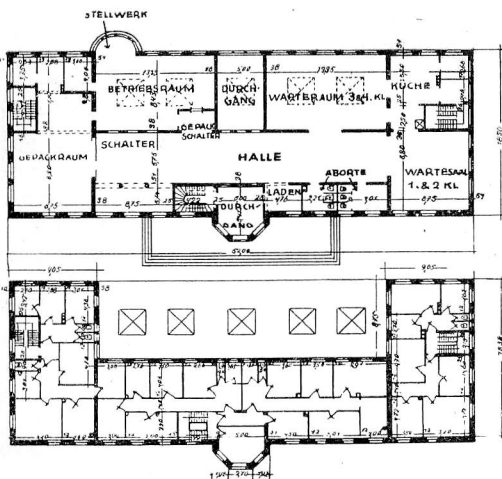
Grundriss des Betriebshauptgebäudes im Bahnhof Bad Tölz.
